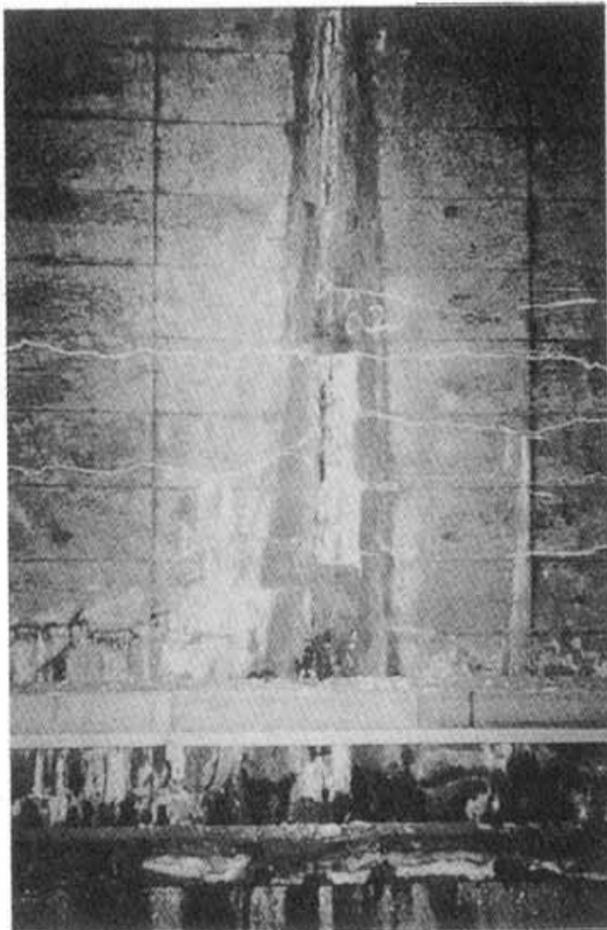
大開～新開地間トンネル部側壁のひび割れ（大開駅の東142m地点の北側壁）
